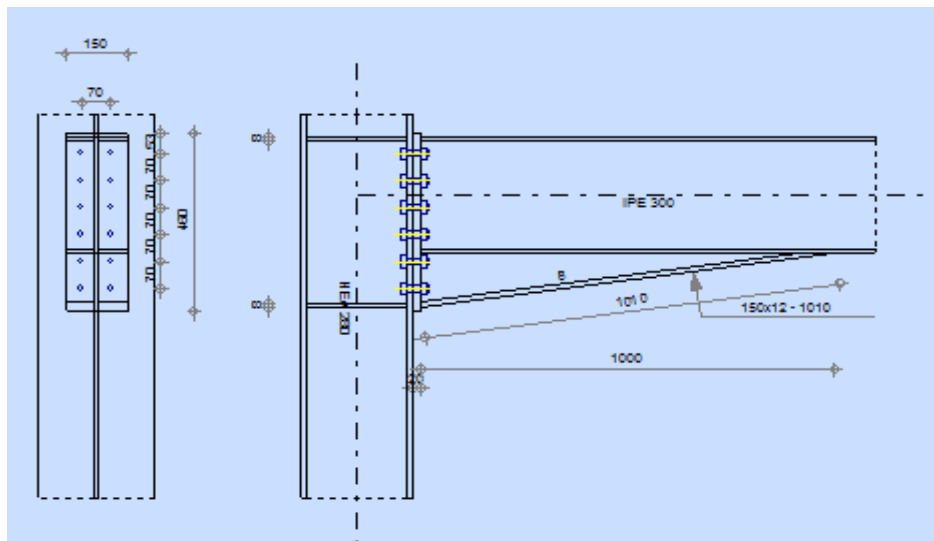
Représentation de l'assemblage poteau-poutre secondaire
